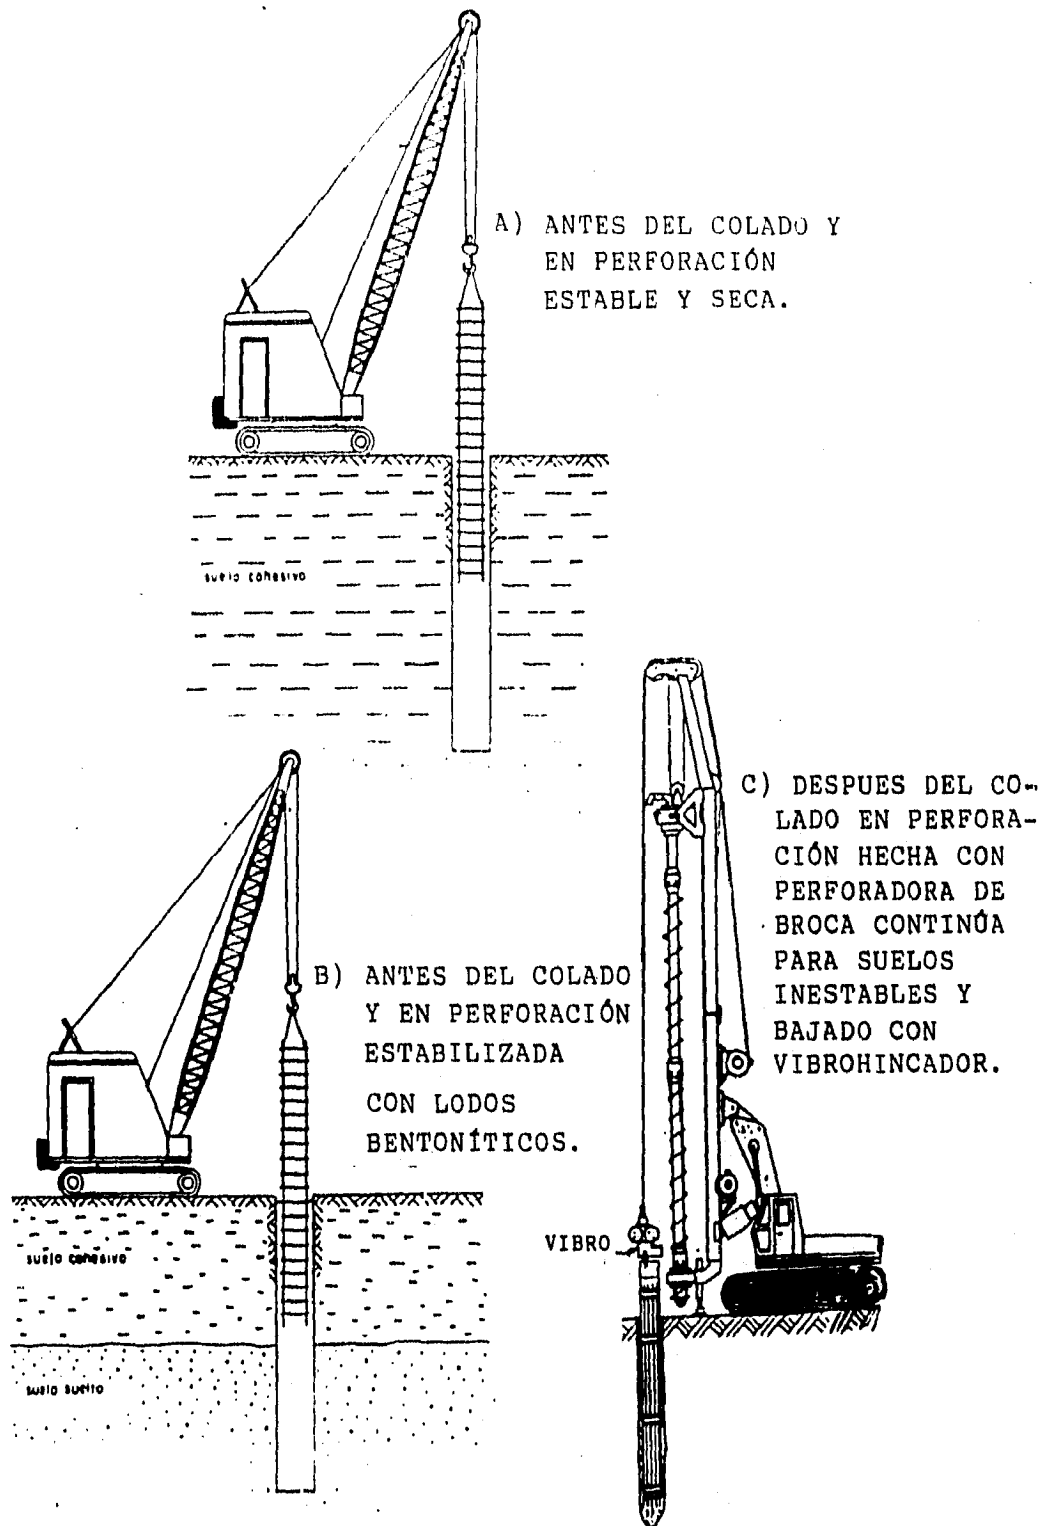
LANZADO DEL ACERO DE REFUERZO.
